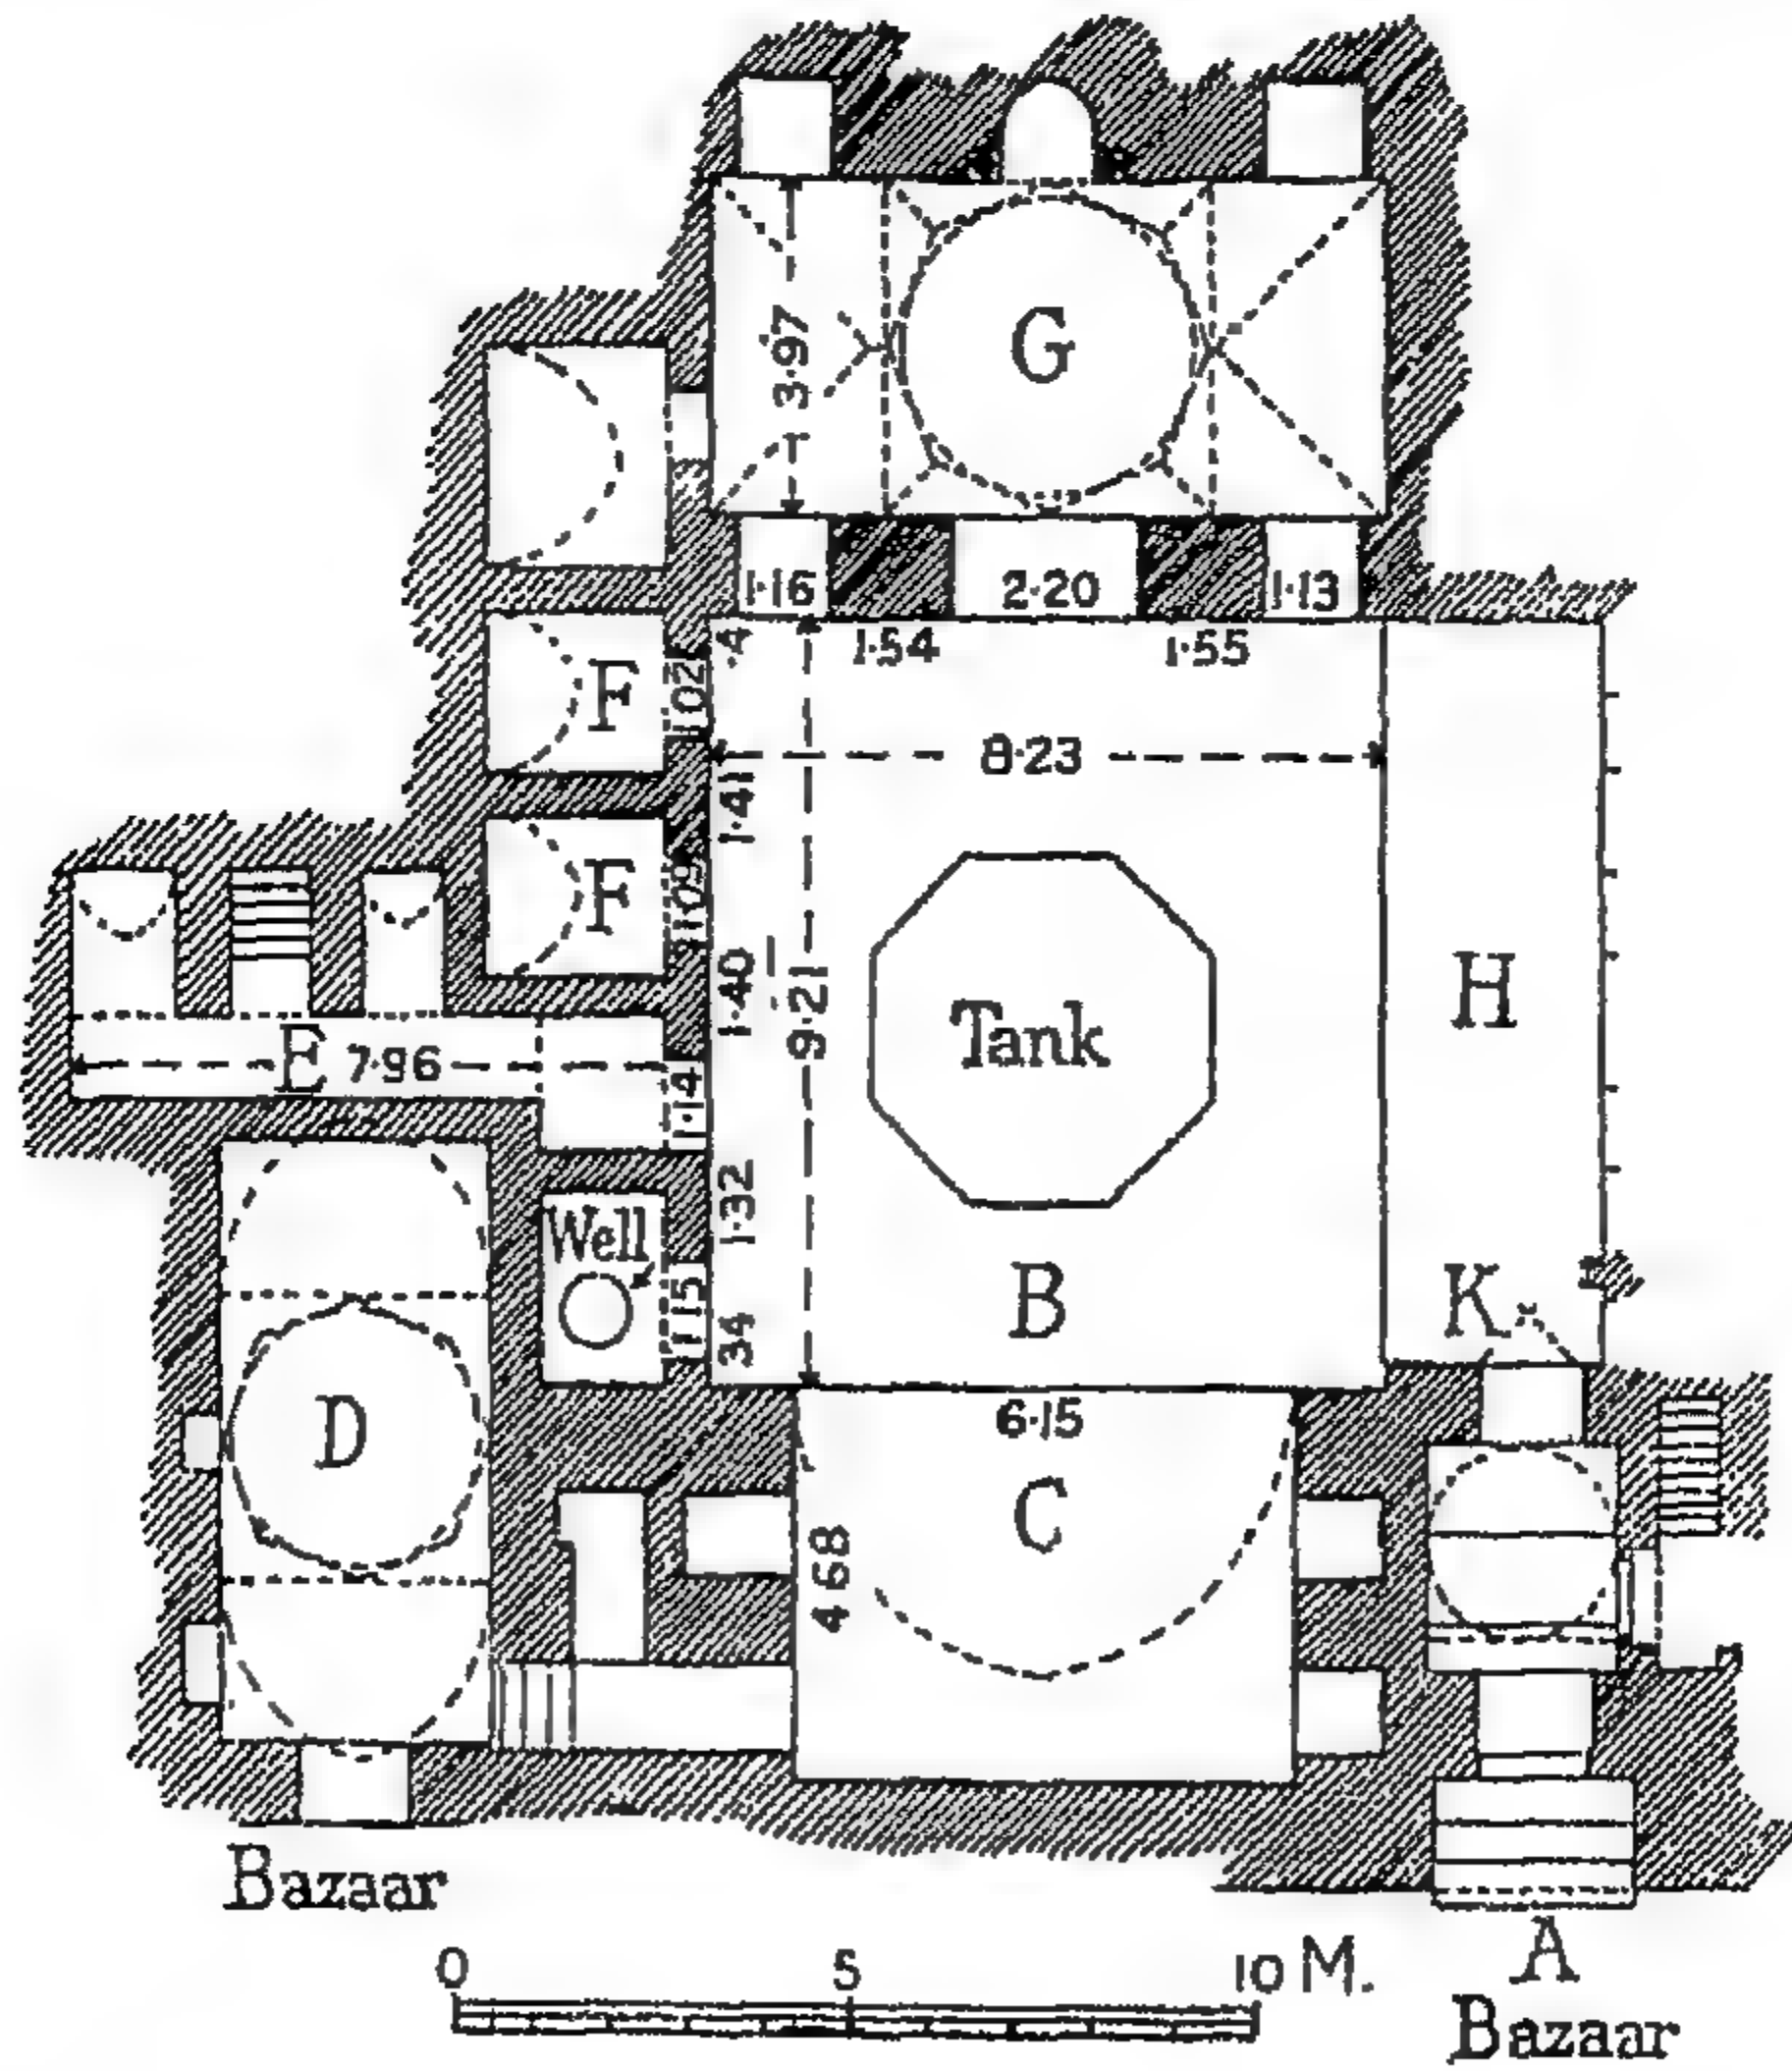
مسقط أفقي لجامع الدرويشية بدمشق (عن : سوفاجيه) .
